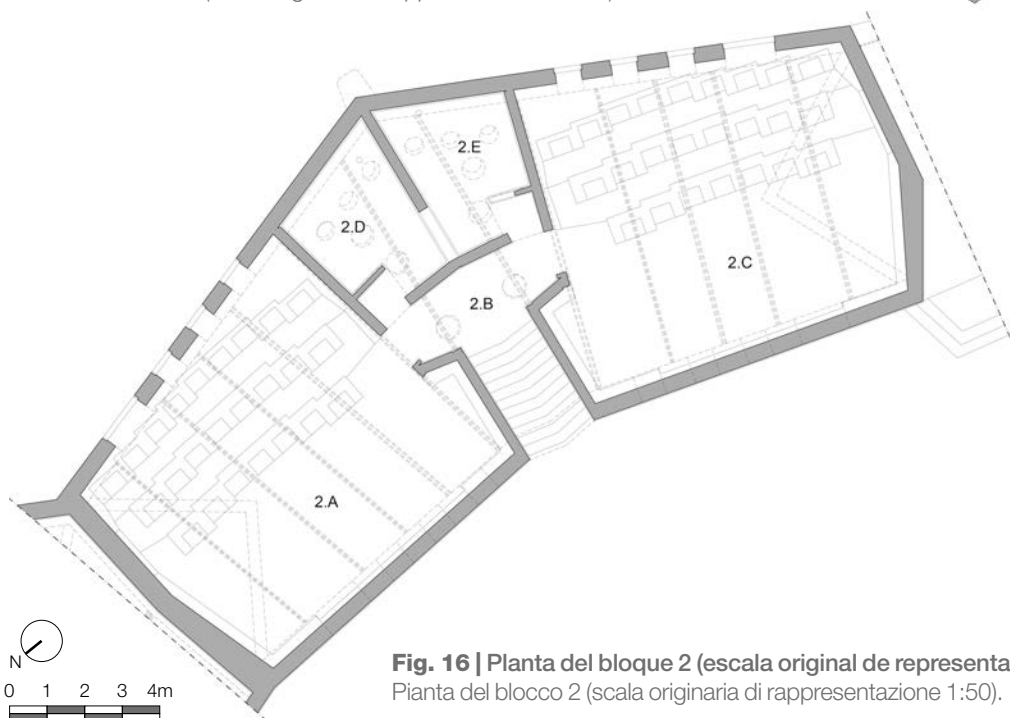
| Planta del bloque 2 (escala original de representación 1:50). |
